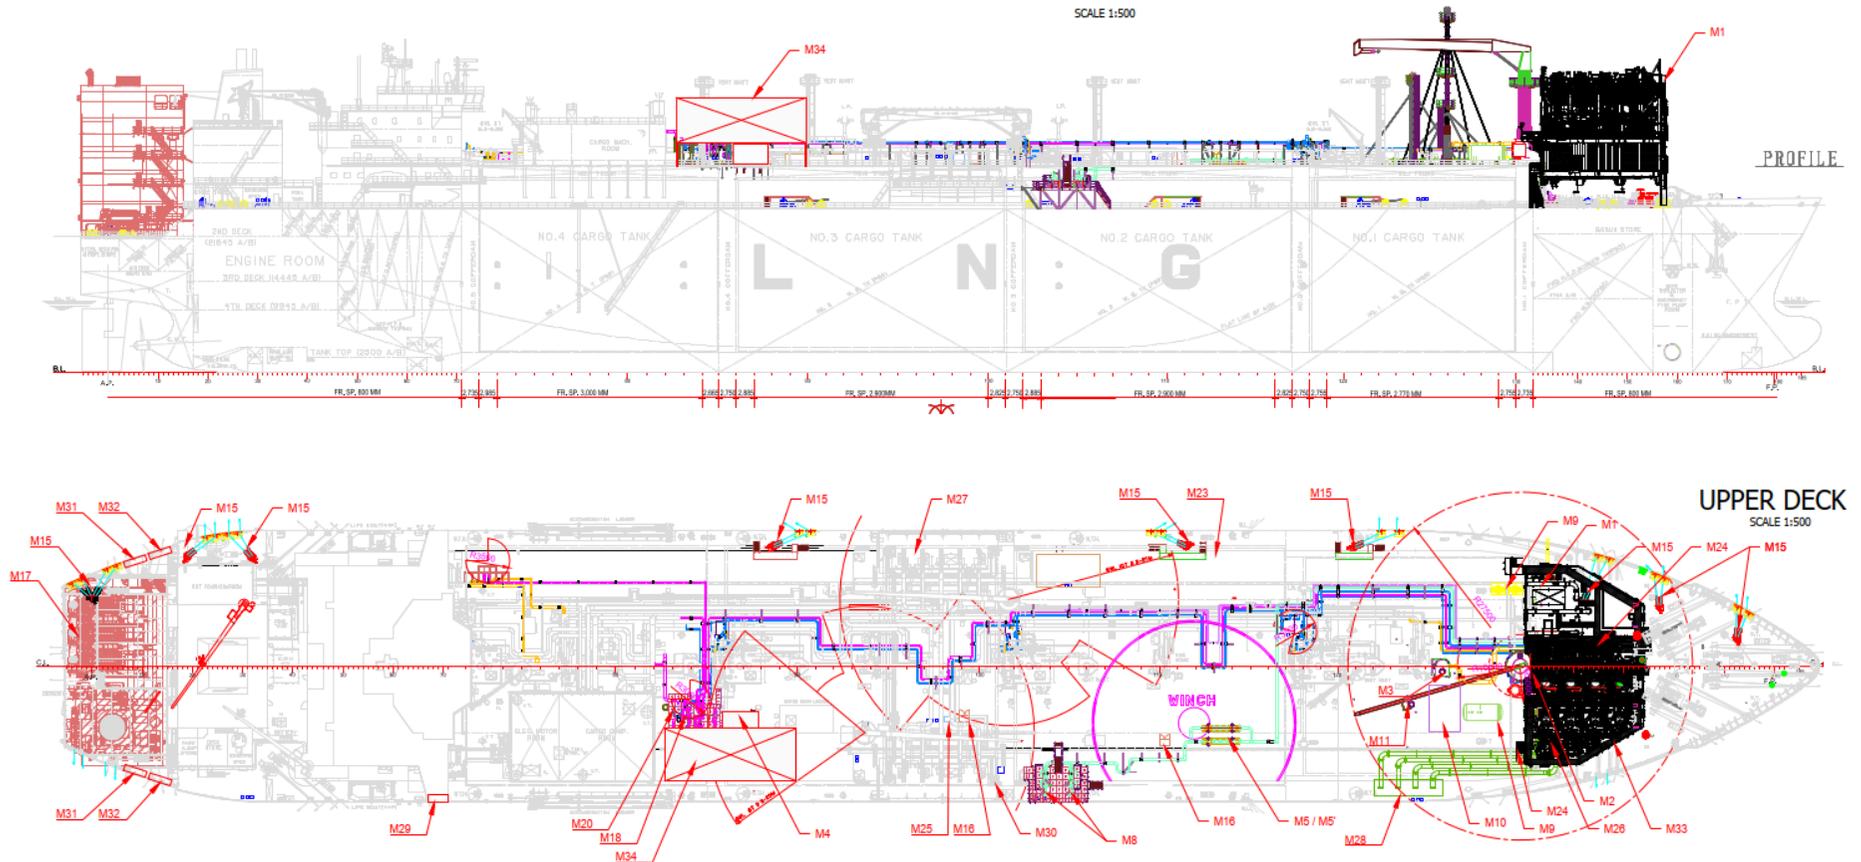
FSRU – Vista in Pianta ed in Sezione
